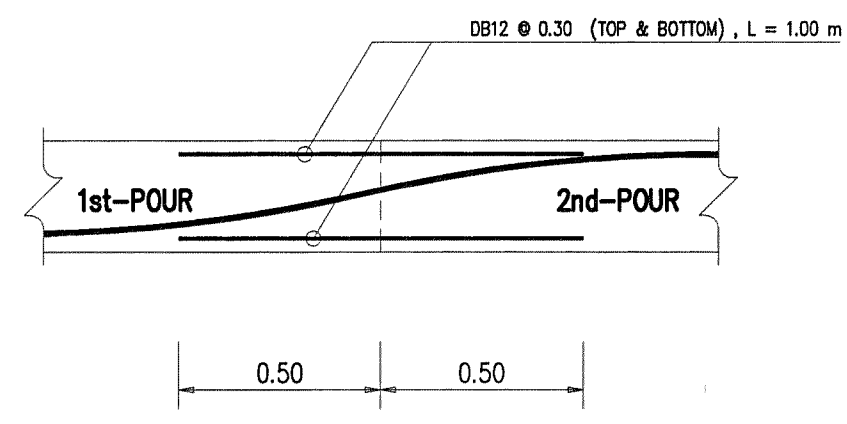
การเสริมเหล็กบริเวณ POUR STRIP
